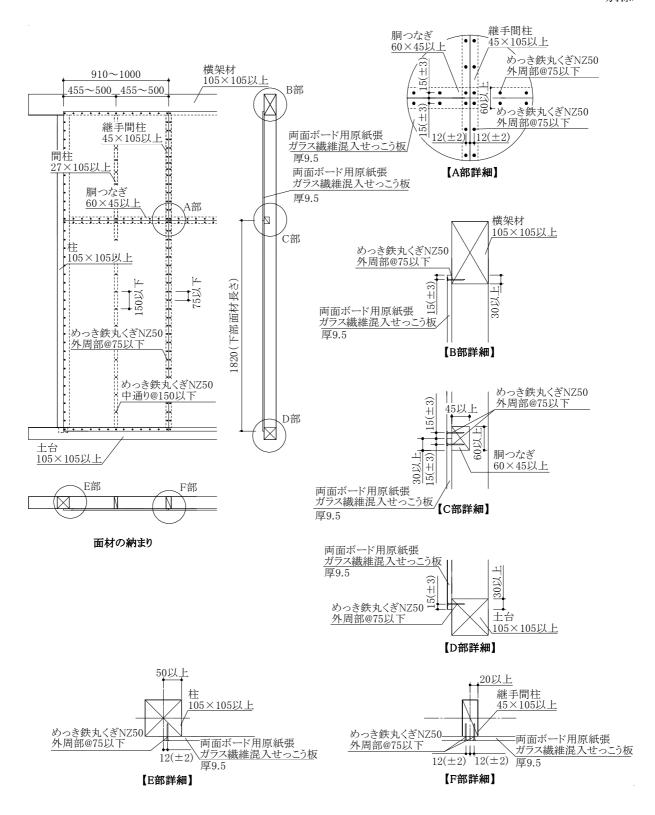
施工図:縦継ぎ張りの場合 (寸法単位:mm)
